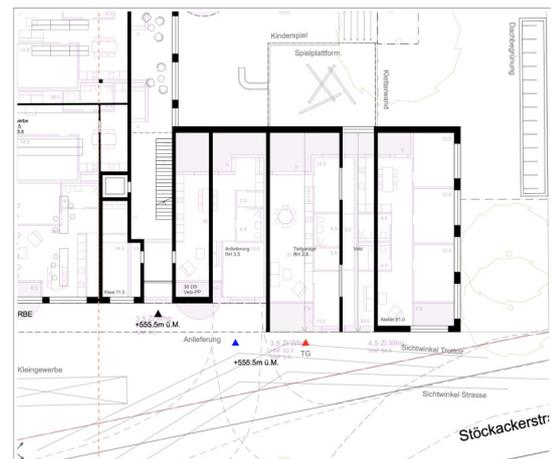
Grundrisse EG und 1.OG (übereinandergelegt) - Darstellung der Grundrissoptimierung bzgl. Lärmschutz
